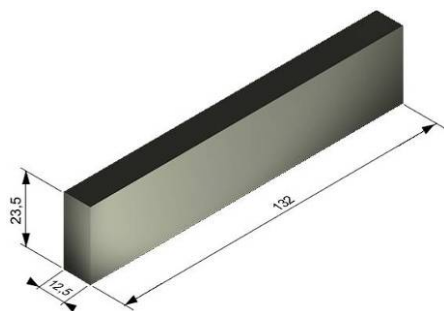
Dimensões da viga de concreto armado confeccionada (medidas em cm).
